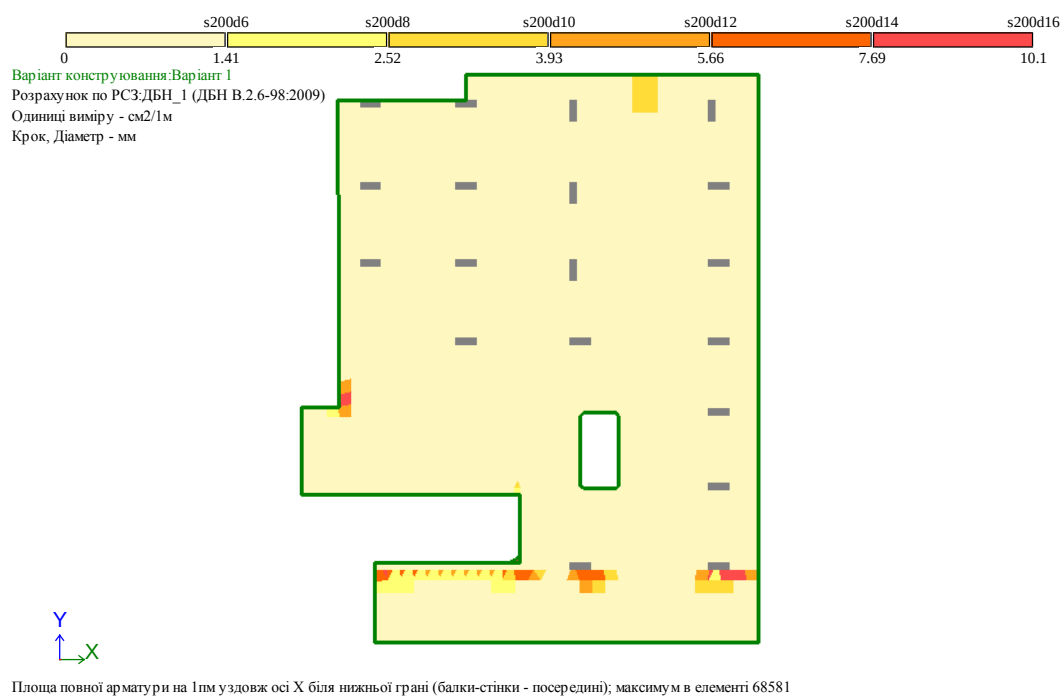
Армування плити перекриття типового поверху половини будівлі (нижня арматура в напрямку осі X)
